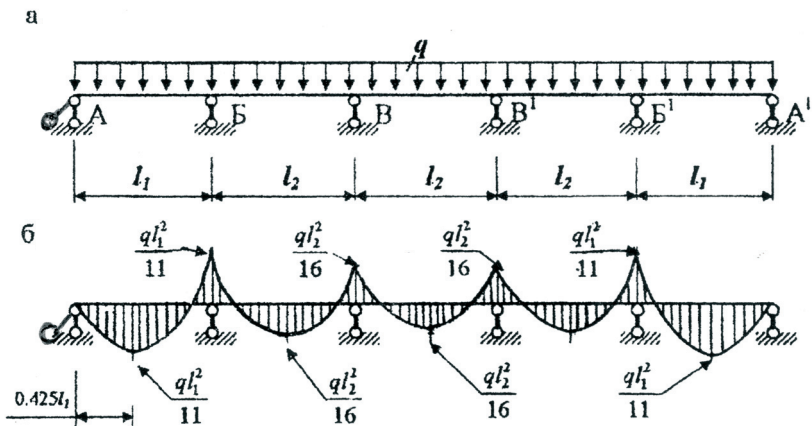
Расчетная схема (а) и эпюра моментов (б) для плиты монолитного перекрытия
